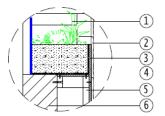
Detalle constructivo de pared y ventana con jardinería en antepecho. Fuente: (Cevallos, 2014)
